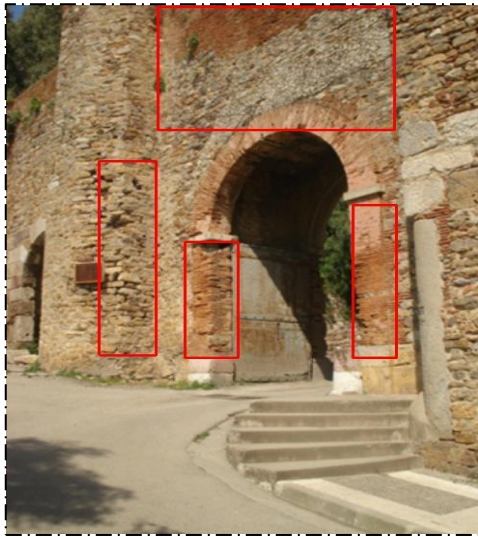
Consolidation du mur avec un avancée Mortier de ciment
